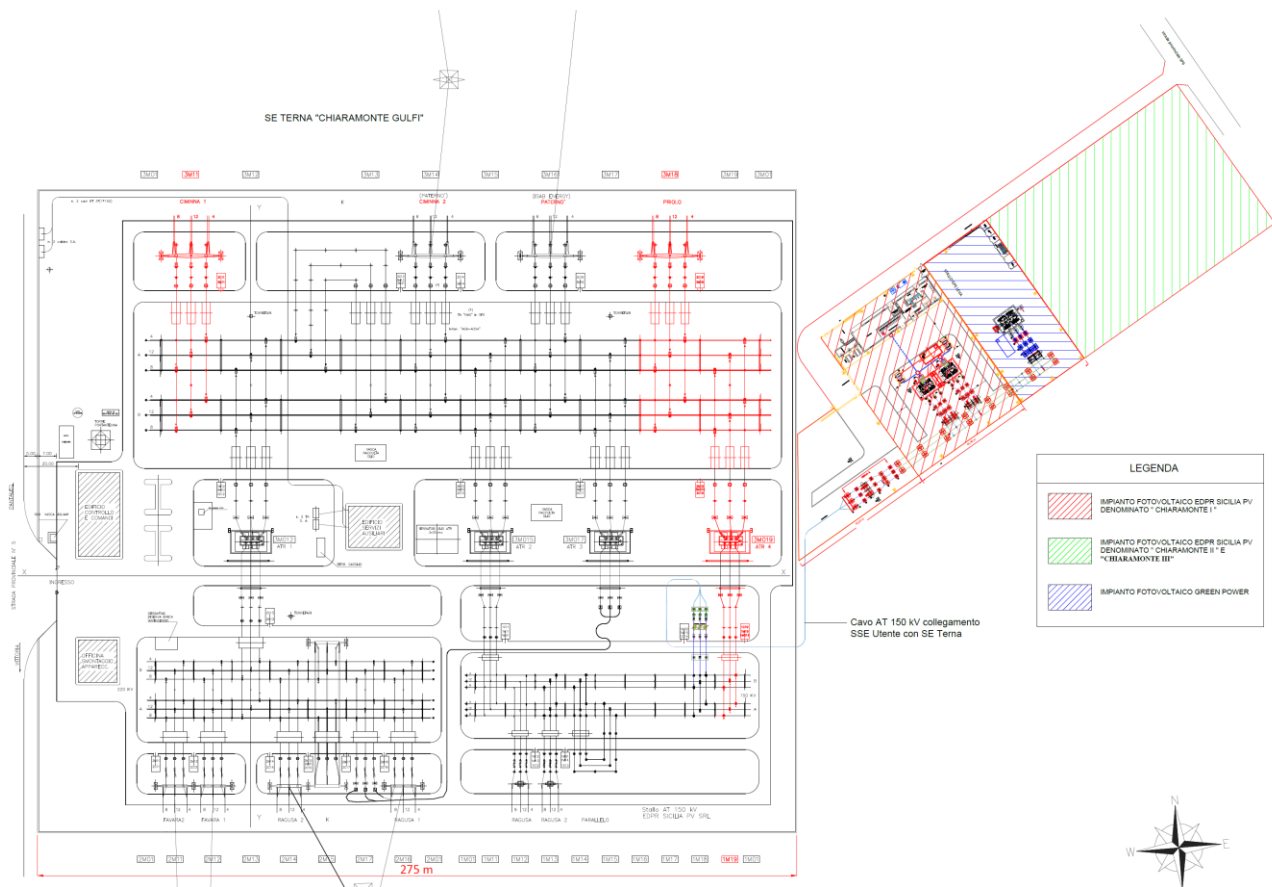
Planimetria generale SSE Chiaramonte Gulfi (RG) e Stallo condiviso
